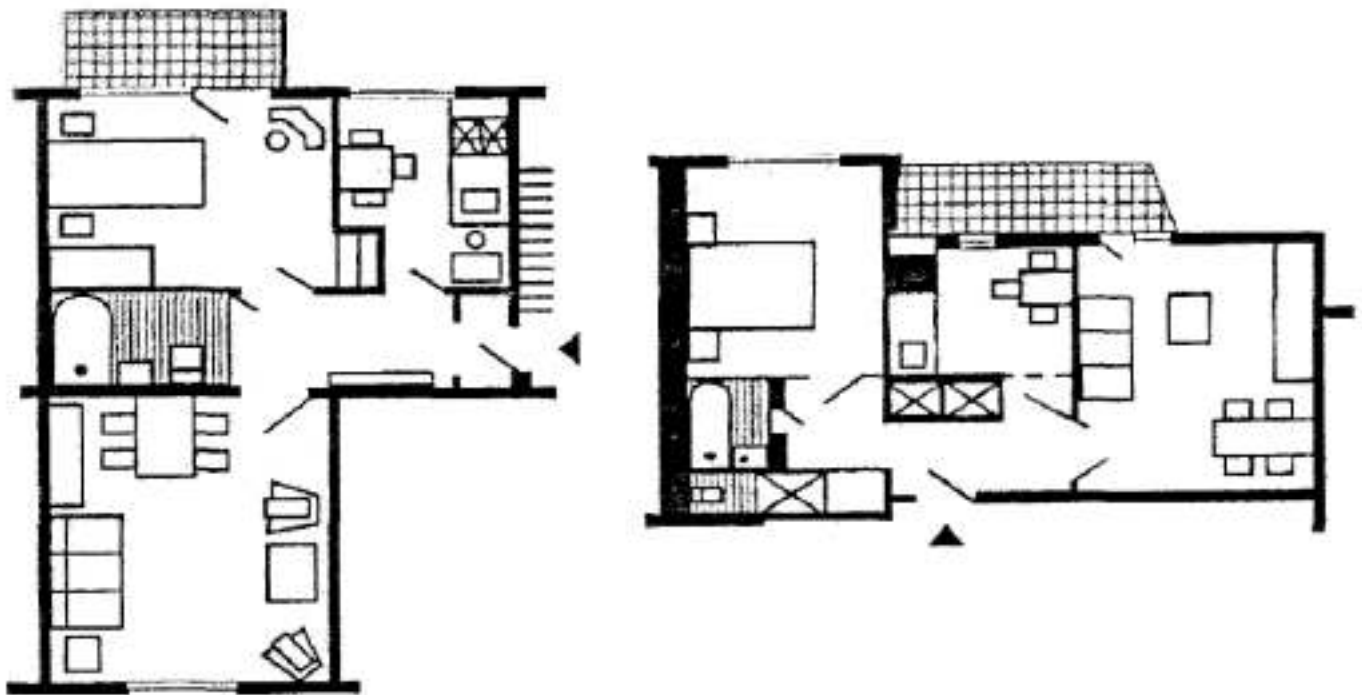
Примеры планировочных решений двухкомнатных квартир
